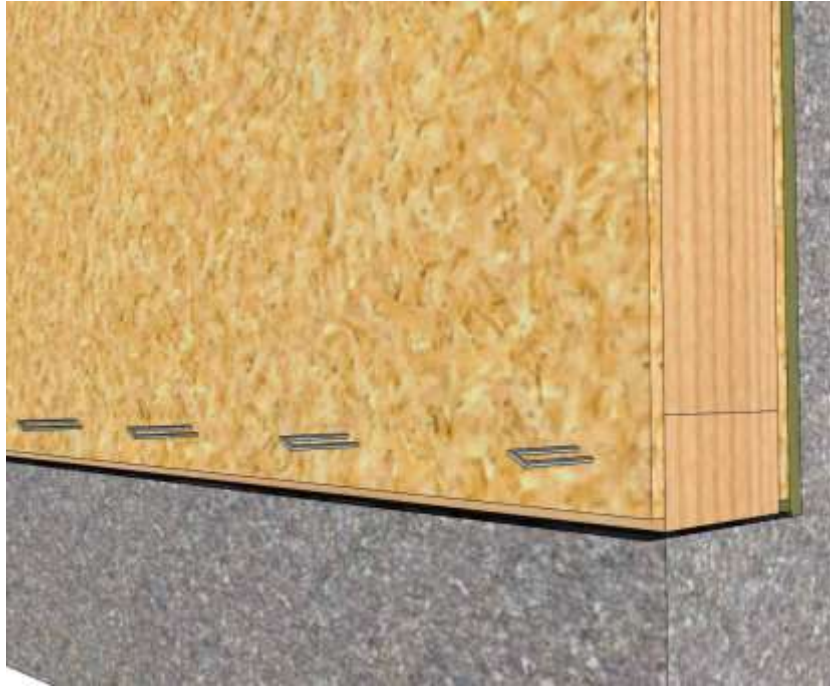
Couturage des plaques de parement intérieur et extérieur sur la lisse d'implantation (cas des façades autoportantes et indépendantes par niveau)
